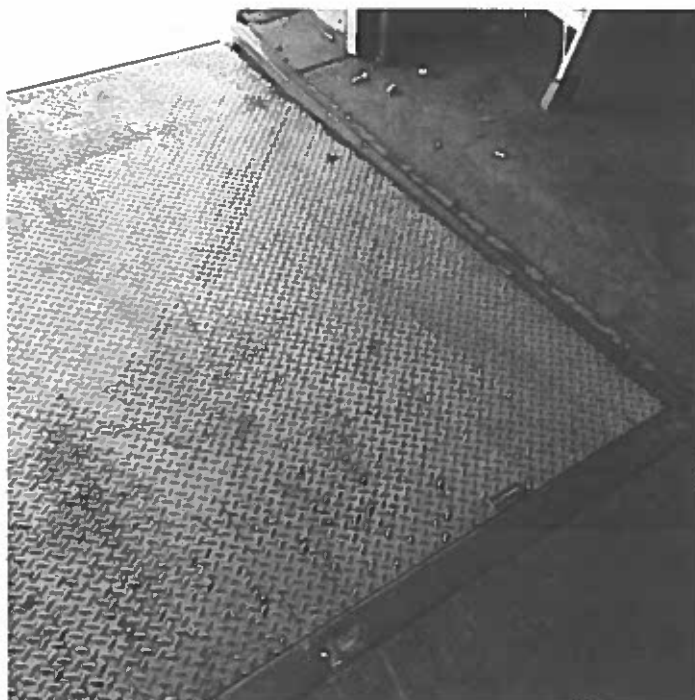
Sous-sol, garage – Plaque métallique au plancher recouvert d'une peinture jaune (échantillon P-6)
